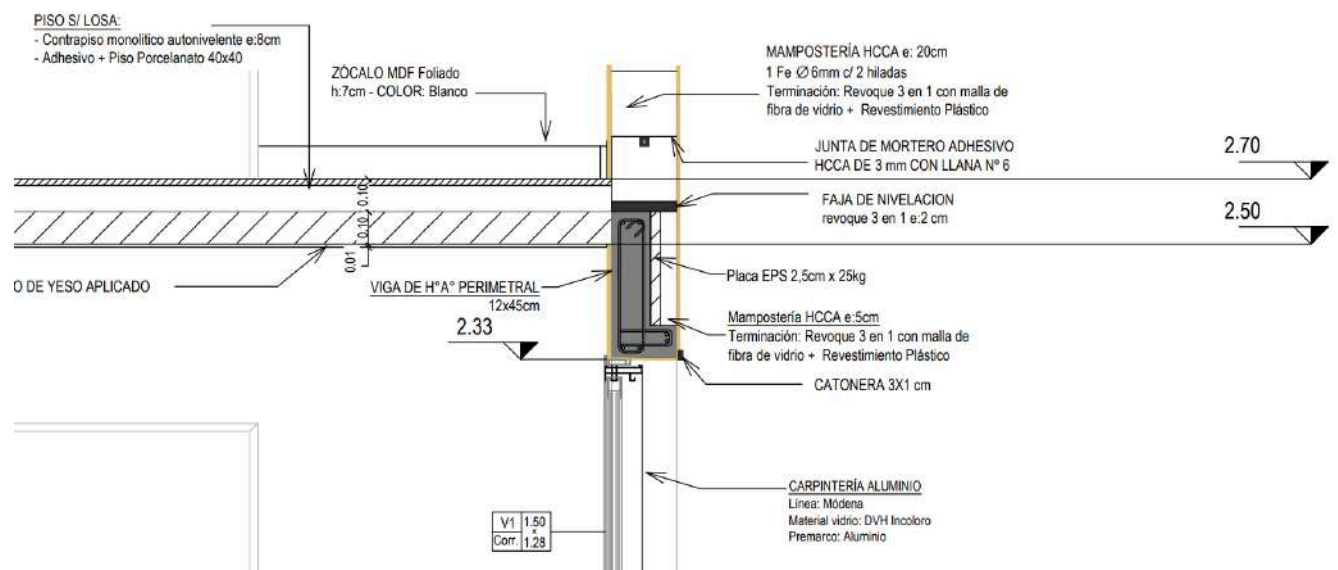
Detalle constructivo sobre planta baja - Plano “A12” - Fuente: Producción propia
